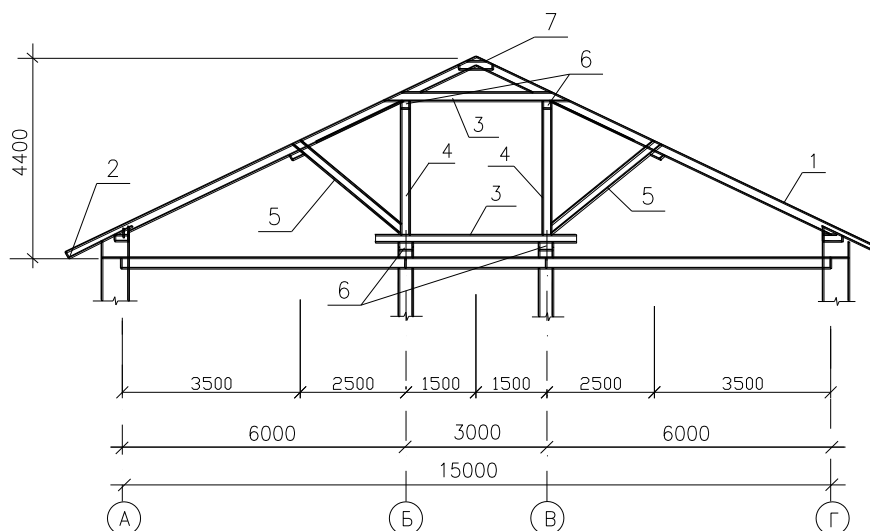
Конструктивная схема расположения стропильной конструкции:
